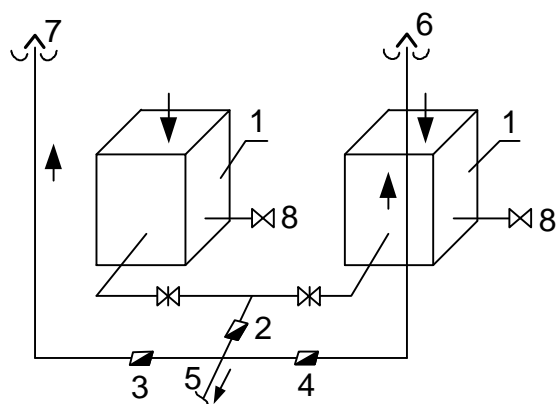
Схема установки воздушных фильтров (поглотителей): 1 – фильтр; 2 – клапан; 3 – клапан; 4 – клапан; 5 – воздуховод к резервуару; 6 – воздушный стояк; 7 – аварийный выпуск воздуха; 8 – выпуск конденсата
